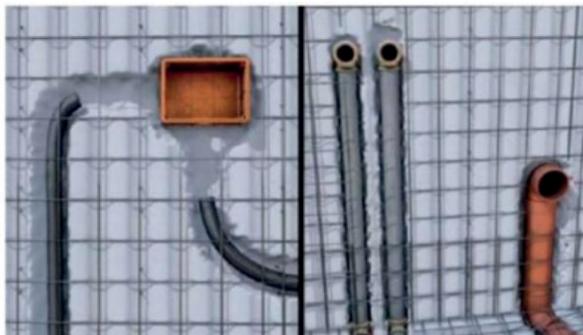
Instalações complementares (Fonte: EMMEDUE, 2014)
